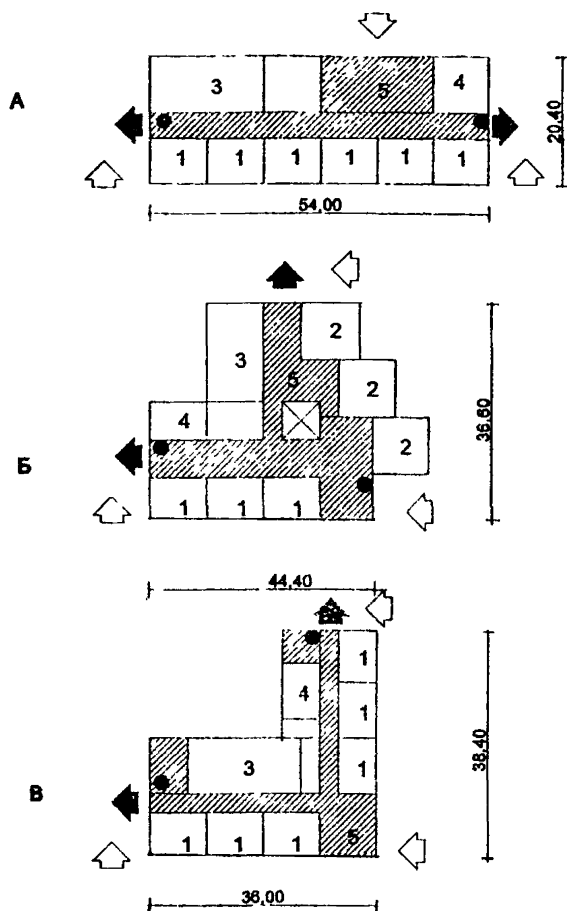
Варианты планировочных схем блоков-пристроек начальной школы на 8 или 12 классов
